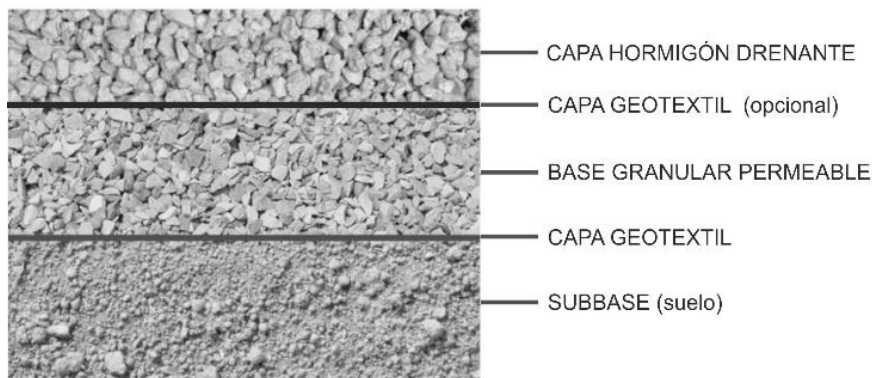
Sección típica de un pavimento de hormigón drenante [40].
